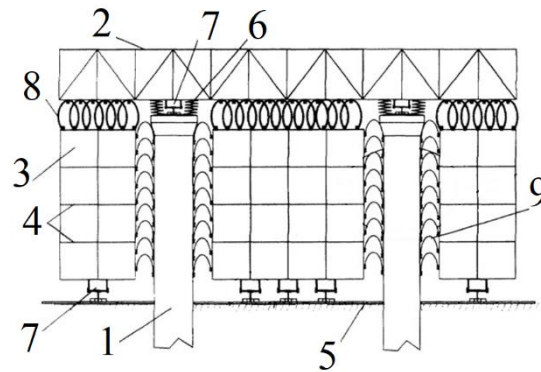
Сейсмостойкое здание подвешеного типа: 1 – опорные стволы; 2 – двухконсольная ферма; 3 – подвесная часть здания; 4 – перекрытия; 5 – фундамент; 6, 8, 9 – упругие элементы; 7 – корректоры жёсткости
